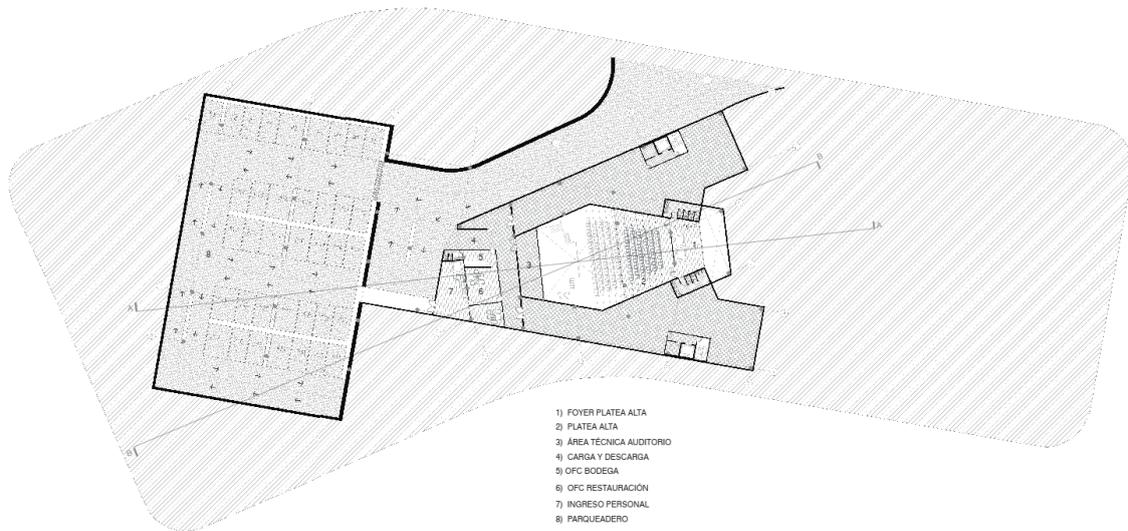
Planta PB + 17.50m. Elaboración propia
